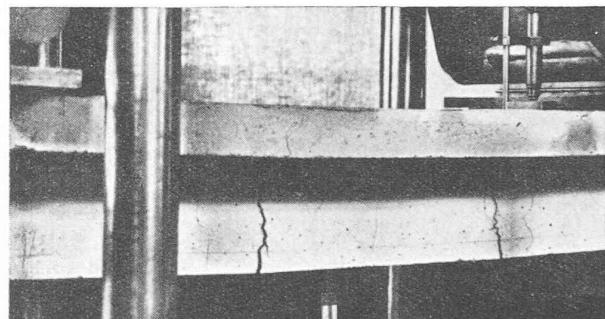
Comparaison des conditions de rupture de 2 poutres en béton, l'une armée d'acier ordinaire (en haut), l'autre armée d'acier Isteck (en bas).
